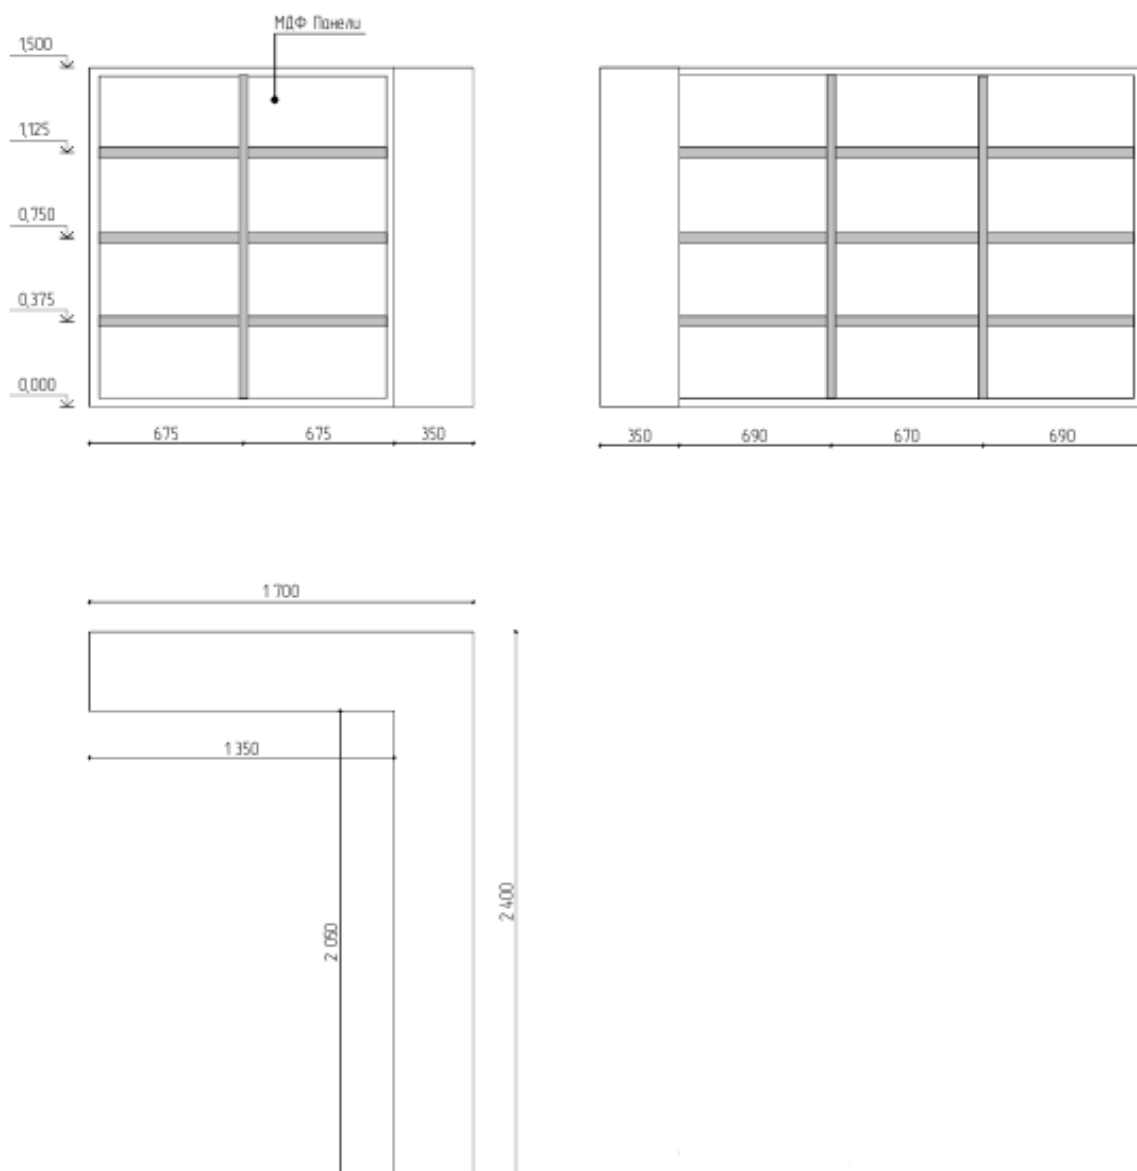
Чертеж углового стеллажа в коворкинг-зоне
